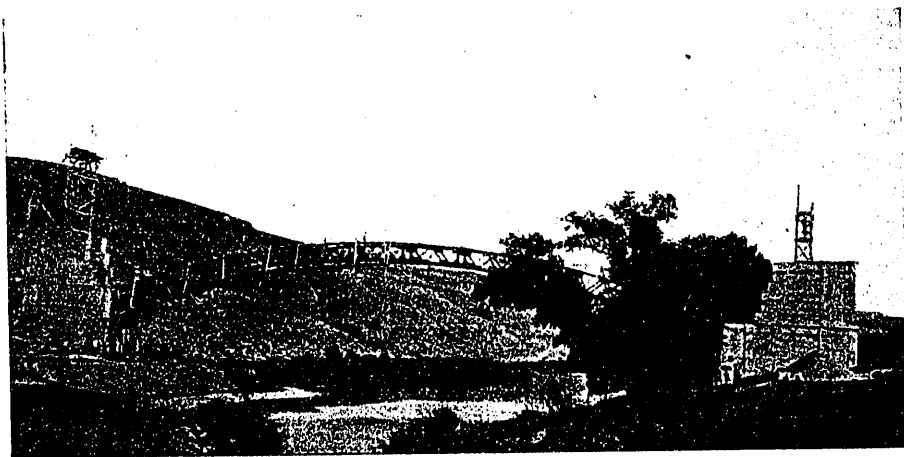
Armadura rígida, parte del encofrado y a la izquierda uno de los castilletes utilizados para el montaje de la armadura
